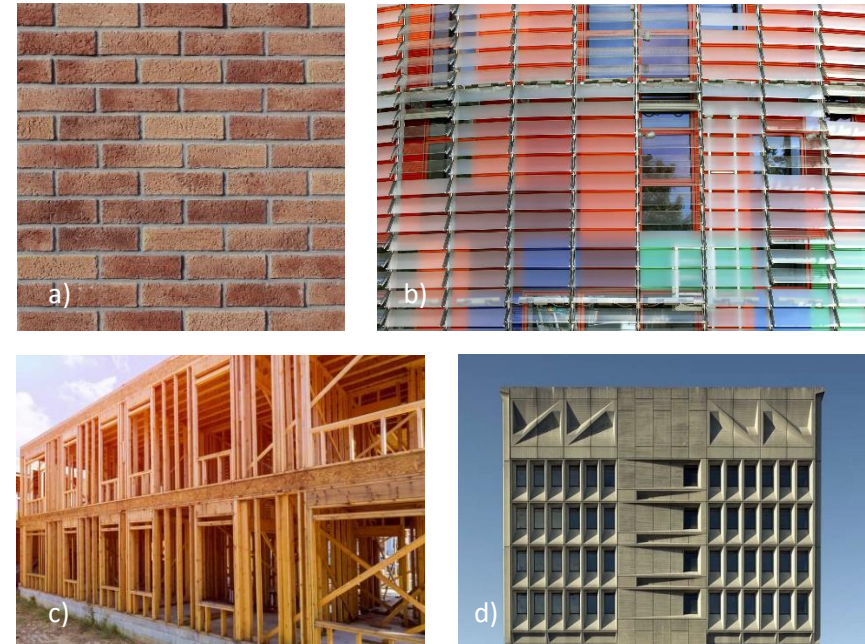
Tipo de fachadas según su composición. a) Maciza, b) Doble, c) Estructura de esqueleto, d) Autoportante.
